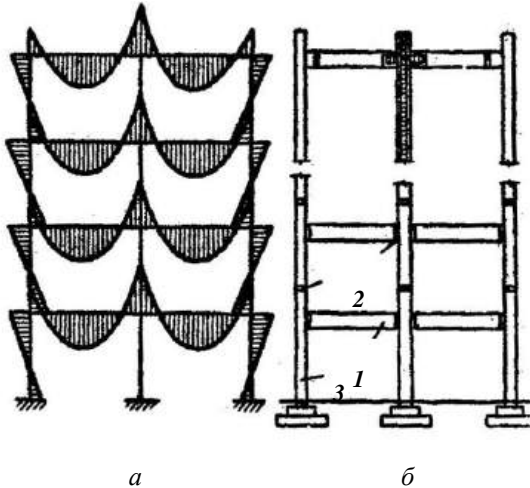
Розрізування конструкцій багатоповерхової рами на збірні елементи: *a* – епюра моментів в елементах багатоповерхової рами; *б* – схема стиків збірних елементів багатоповерхової рами; 1 – ригель; 2 – стик; 3 – колона
